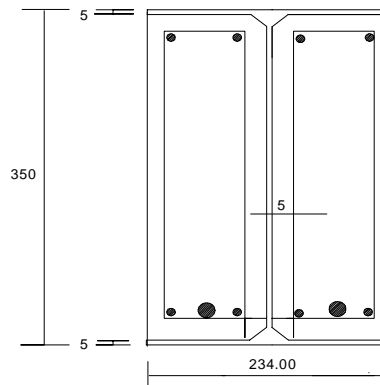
Seção Transversal da Viga Soldada Especificada
